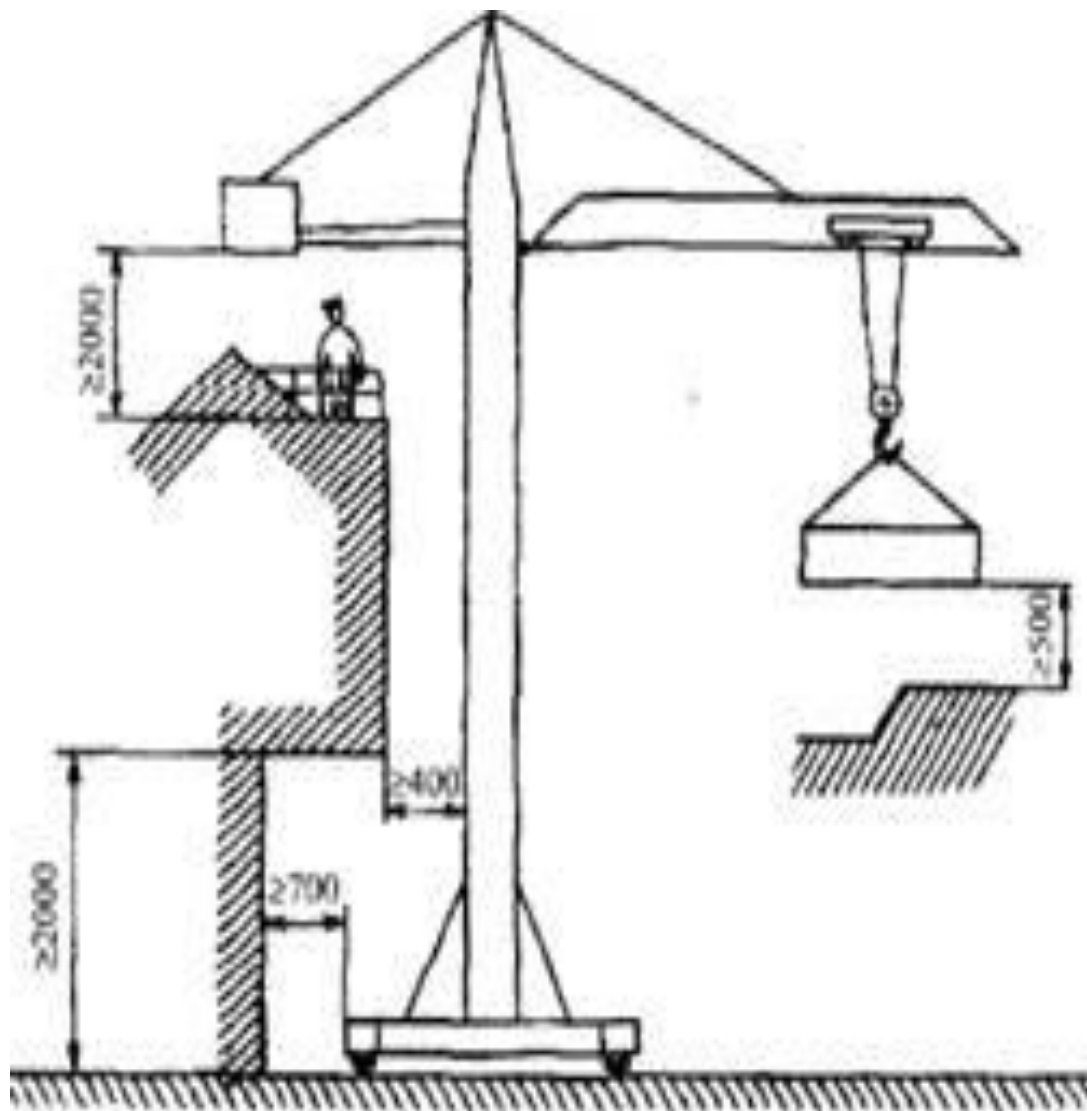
Схема установки кранов, передвигающихся по наземным рельсовым путям
